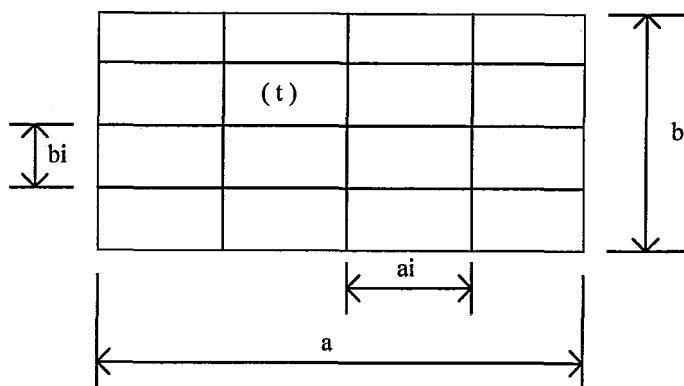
Reprodução da figura 5-8 da BV-104 (1981)
